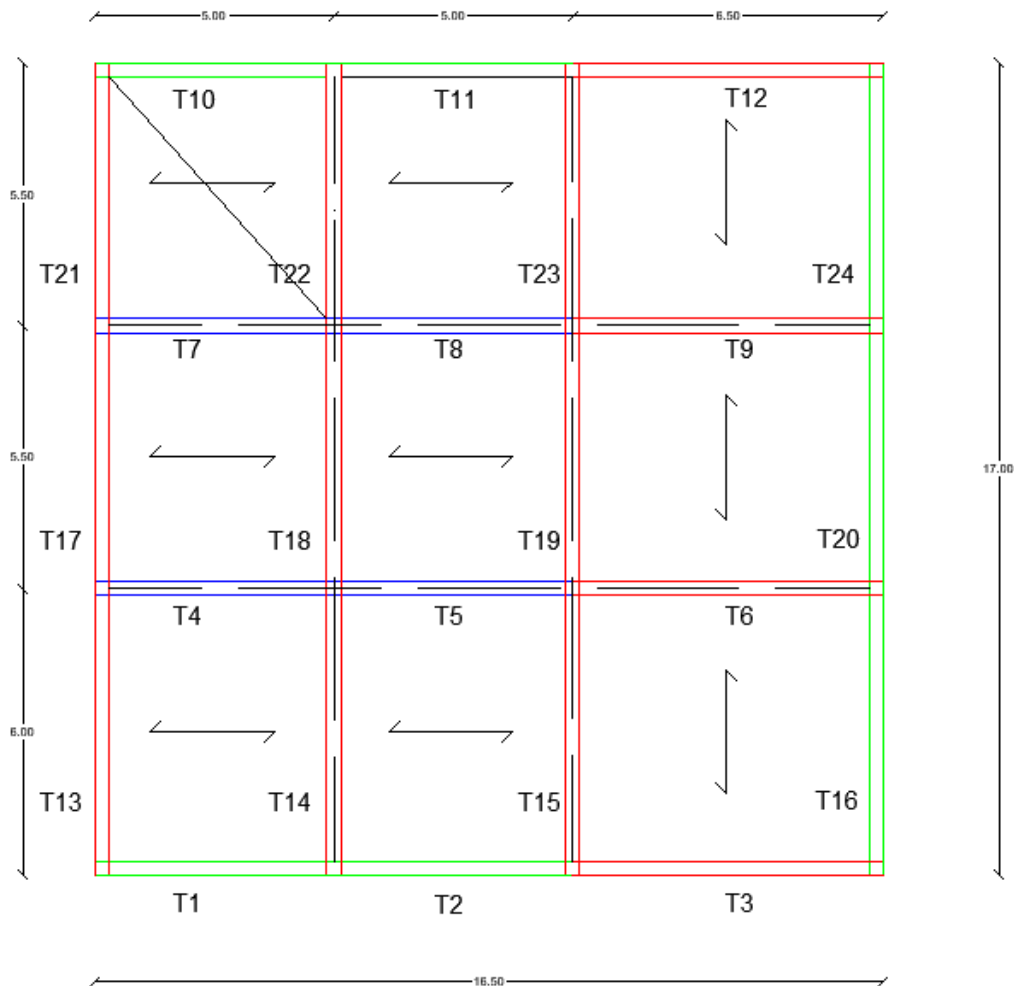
Pianta con orditura del solaio e classificazione delle travi
